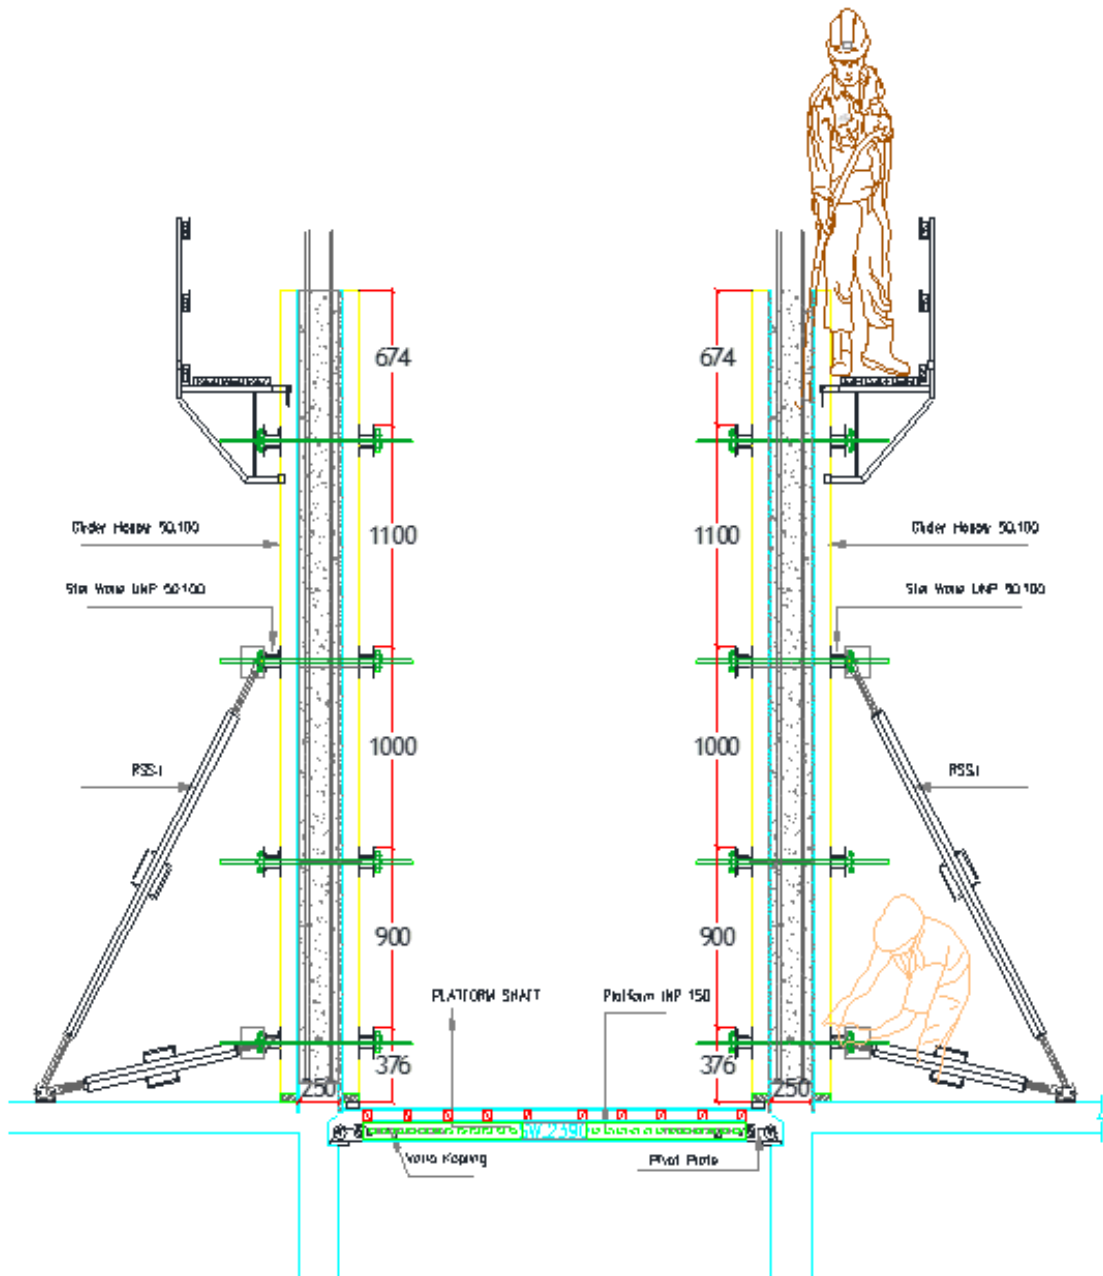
Ilustrasi pemasangan Bekisting dan Corewall dengan Tadano
